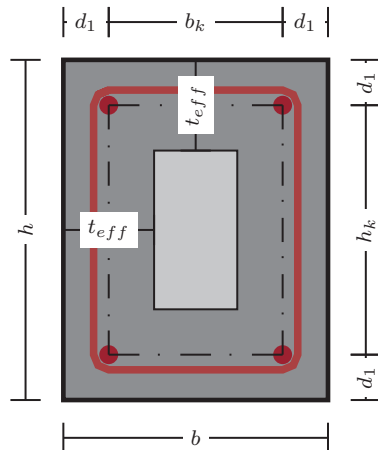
Konstruktion eines Hohlkastens für einen Stahlbeton-Rechteckbalken
